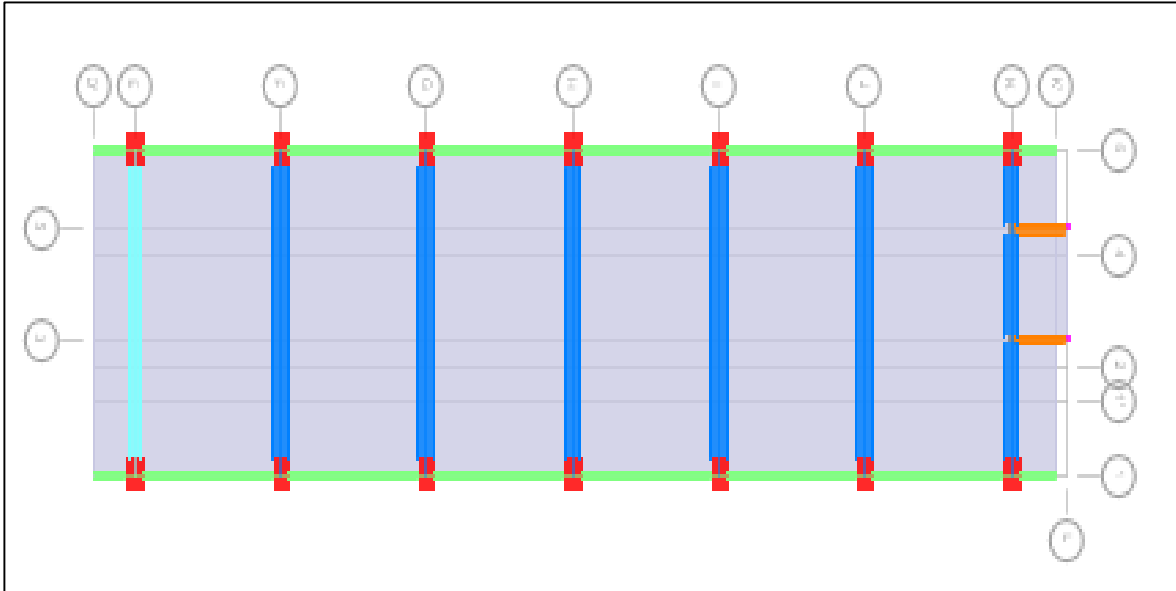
Planta N+11.68 Estructura 3.1 Torre Occidental
